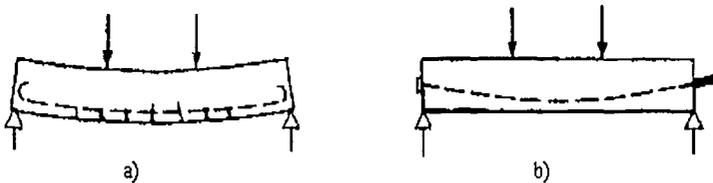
Representación de esfuerzos de tensión en el concreto. a) Viga simplemente reforzada. b) Viga presforzada.
